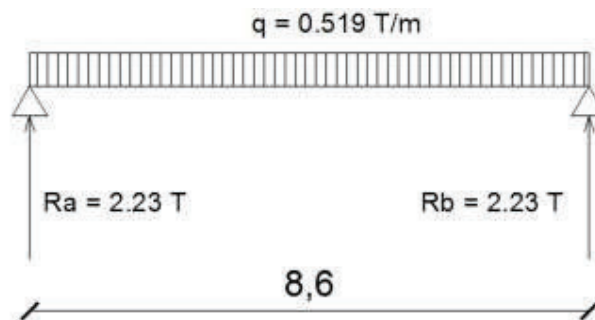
LOSA PARA EJEMPLO Y VIGA INTERNA
